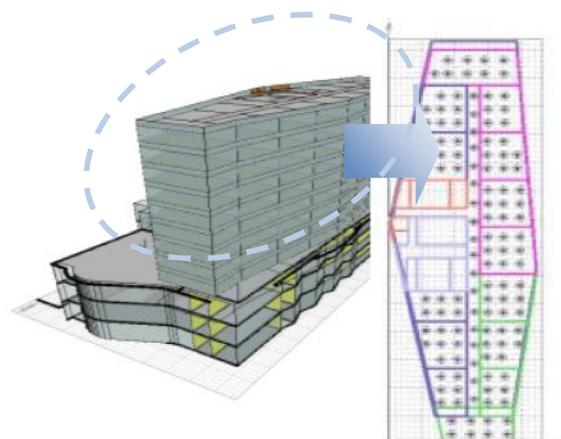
Denah Lantai 1 dan Lantai Tipikal (Lantai 5-9)
